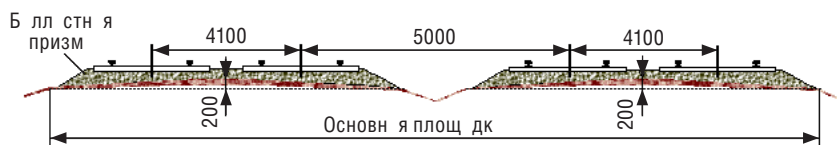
Расстояние между осями путей на многопутных перегонах
